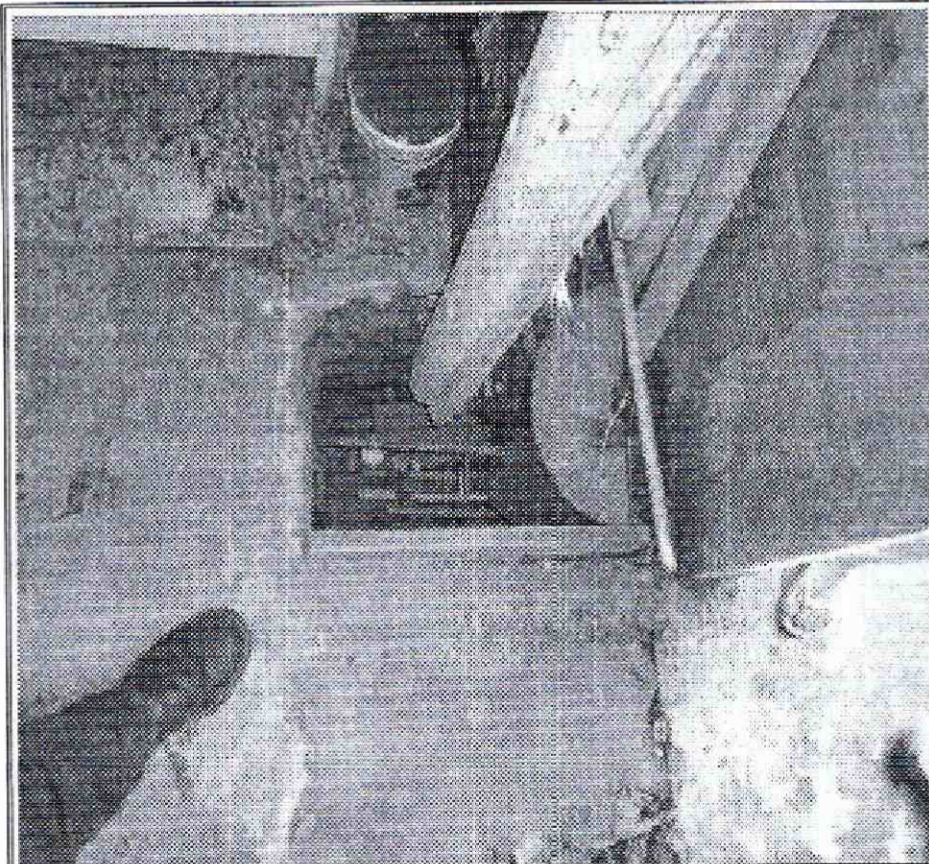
Excavaciones posiblemente realizadas para la cimentación de la construcción
